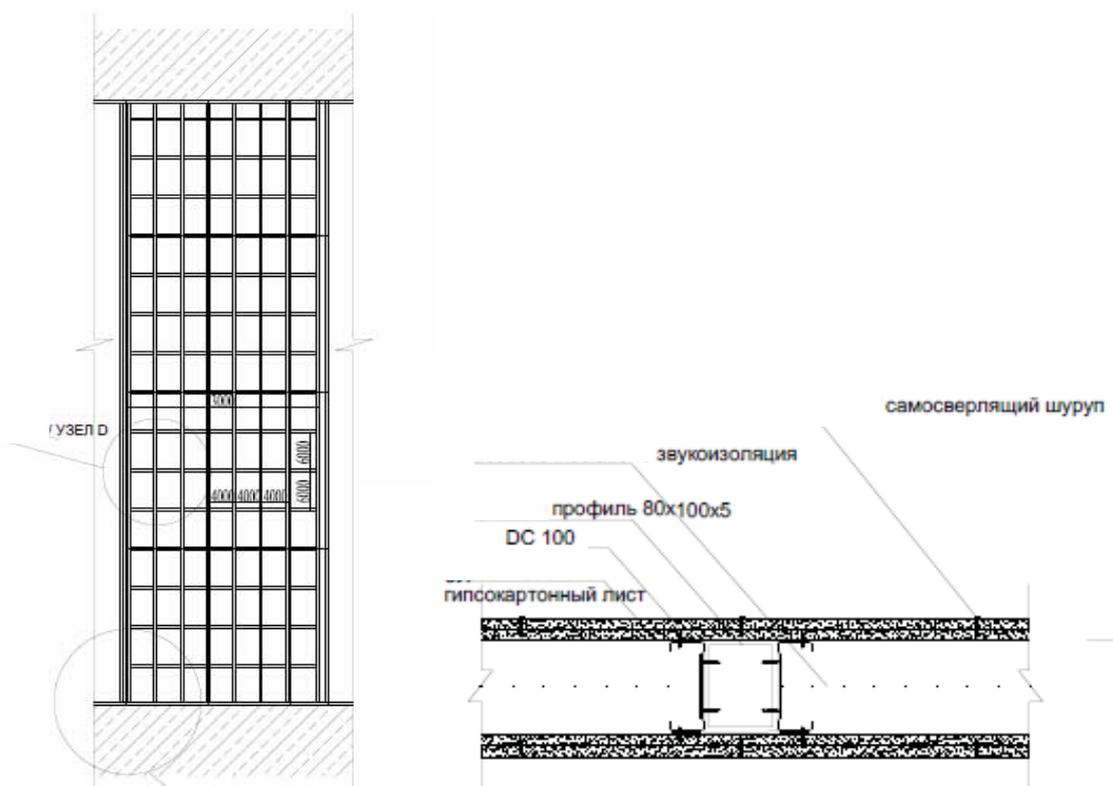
Схема и сечение внутреннего фасада (атриум) из гипсокартонной стены.
